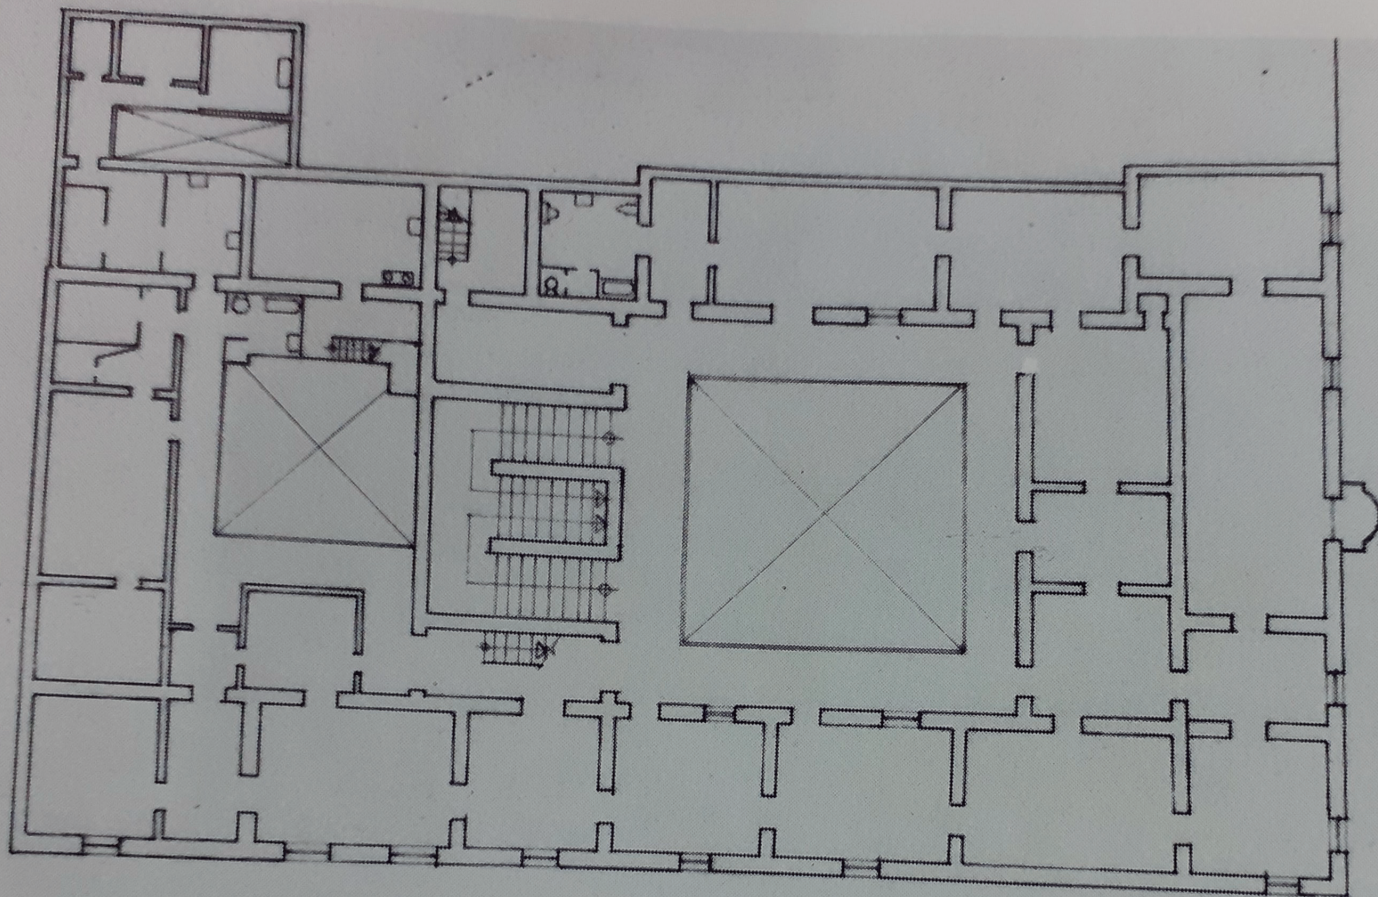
Vista del plano de la planta baja anterior al proyecto de restauración de 1963. Adaptado de "Vista del plano de la planta baja antes del proyecto de restauración" (p. 16), por Héctor Velarde, 1963, Revista Peruana de Cultura, I.
